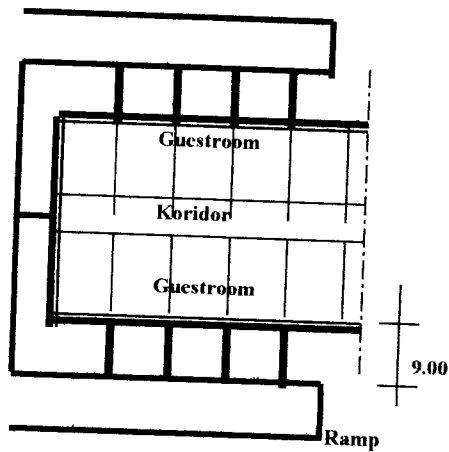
Bentuk plat lantai yang sesuai dengan aturan ketinggian lantai
